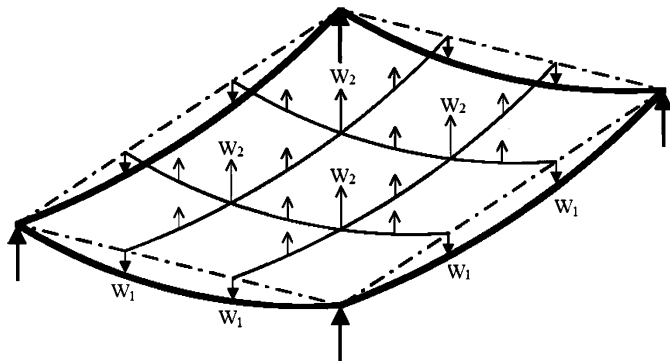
Распределение вертикальных усилий в конструктивной ячейке от вертикальной составляющей усилий натяжения
